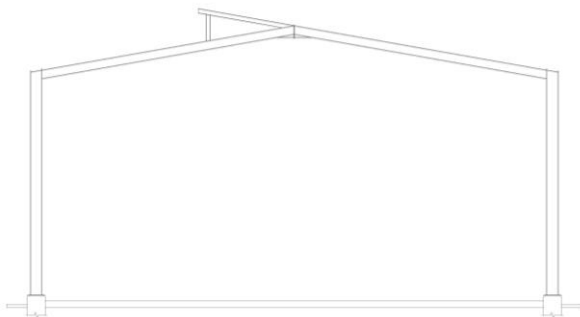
Desain Framing Portal Bangunan Konstruksi Baja Sistem *Pre-engineering Building
